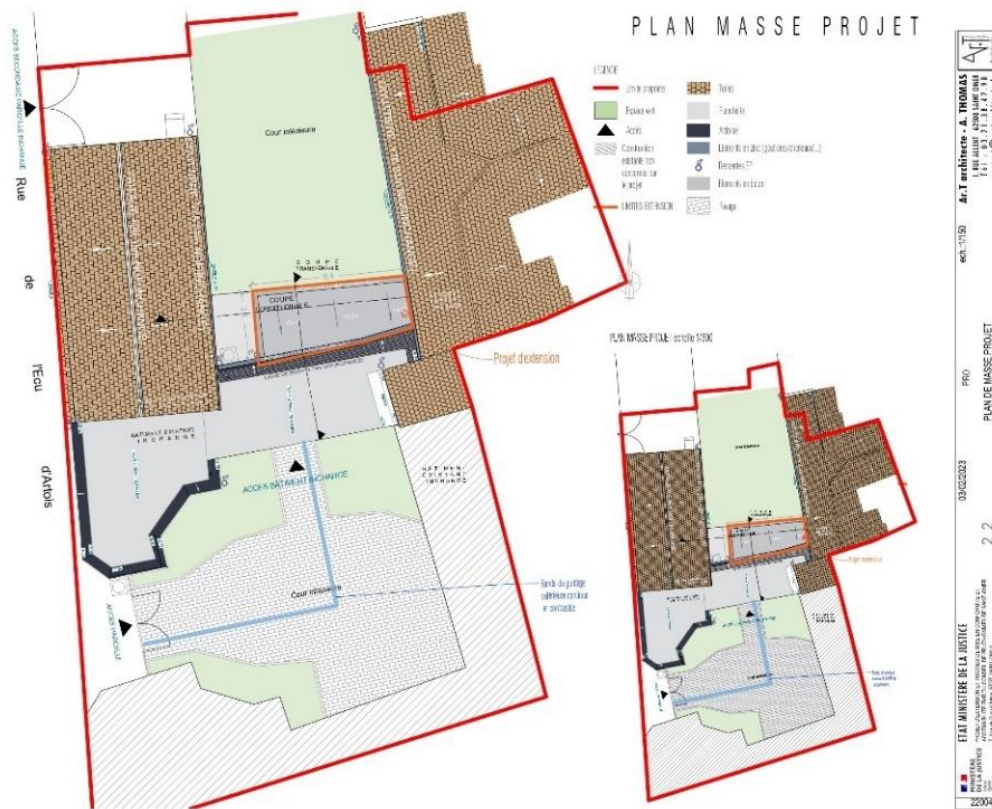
plan de masse du projet (Source : Ar.t architecte)
